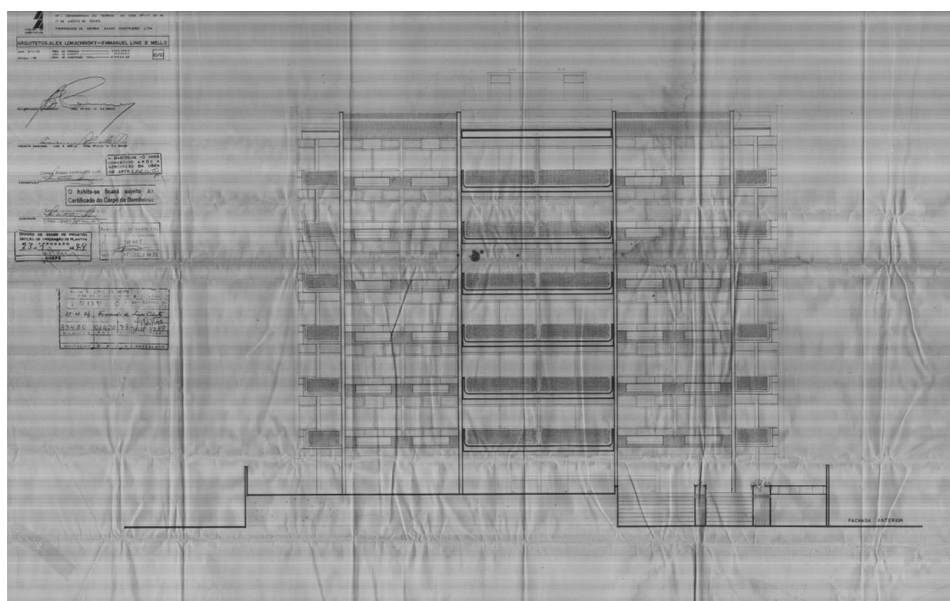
Fachada do edifício Banguê, 1973. Fonte: Arquivo da Prefeitura do Recife (1973).
